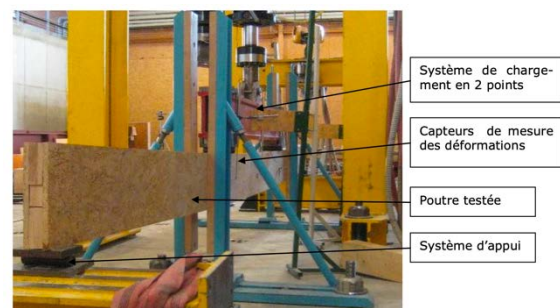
Tests d'une poutre caissons en hêtre sur le banc d'essai du CRITT bois pour la construction de la Ruche de Tendon, 2010 (© Haha).
